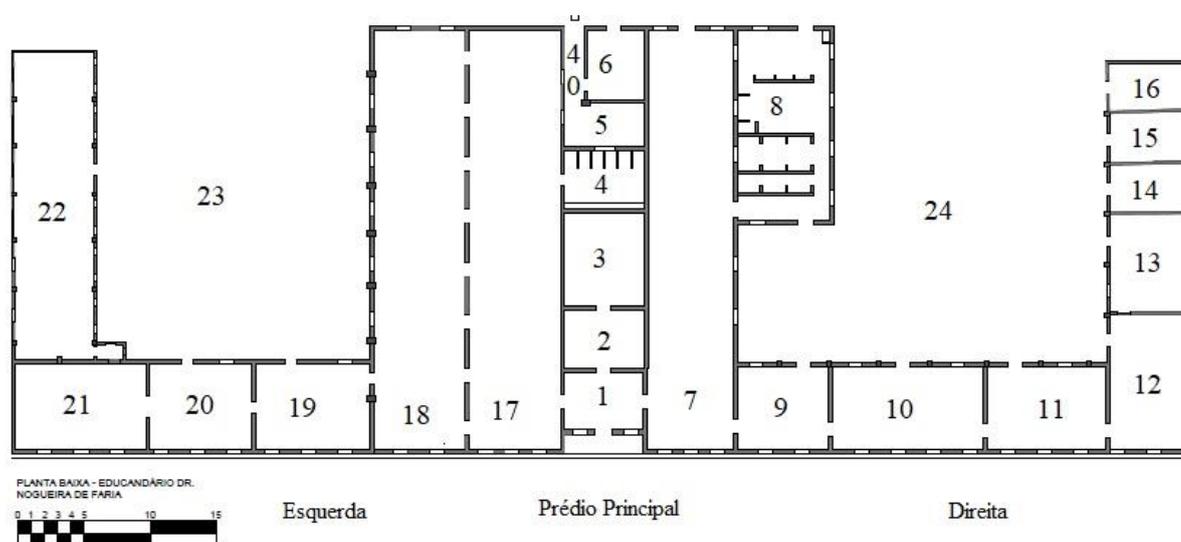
Planta baixa do prédio principal. Desenho: Celso Vieira e Carol Seabra.
